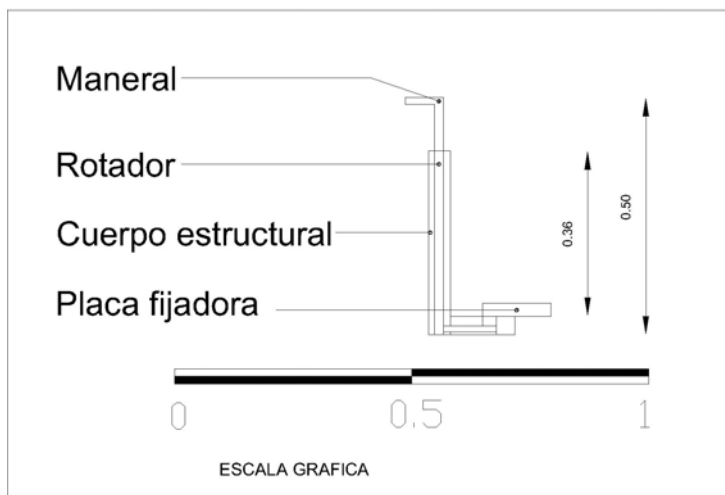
Sistema de fijación de los contenedores a la losa de cimentación.
